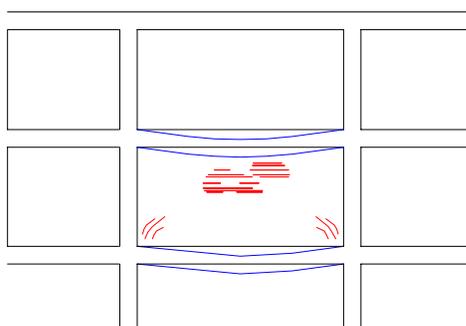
Fissuras causadas por uma flecha maior na viga superior
